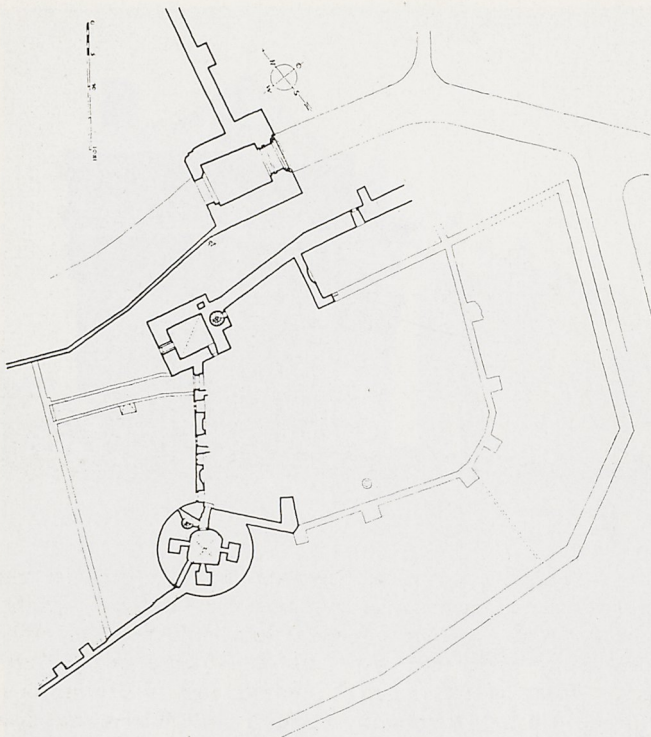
Lageplan der erzbischöflichen Burg in Andernach. (Grundriß nach F. Krause, 1921)
